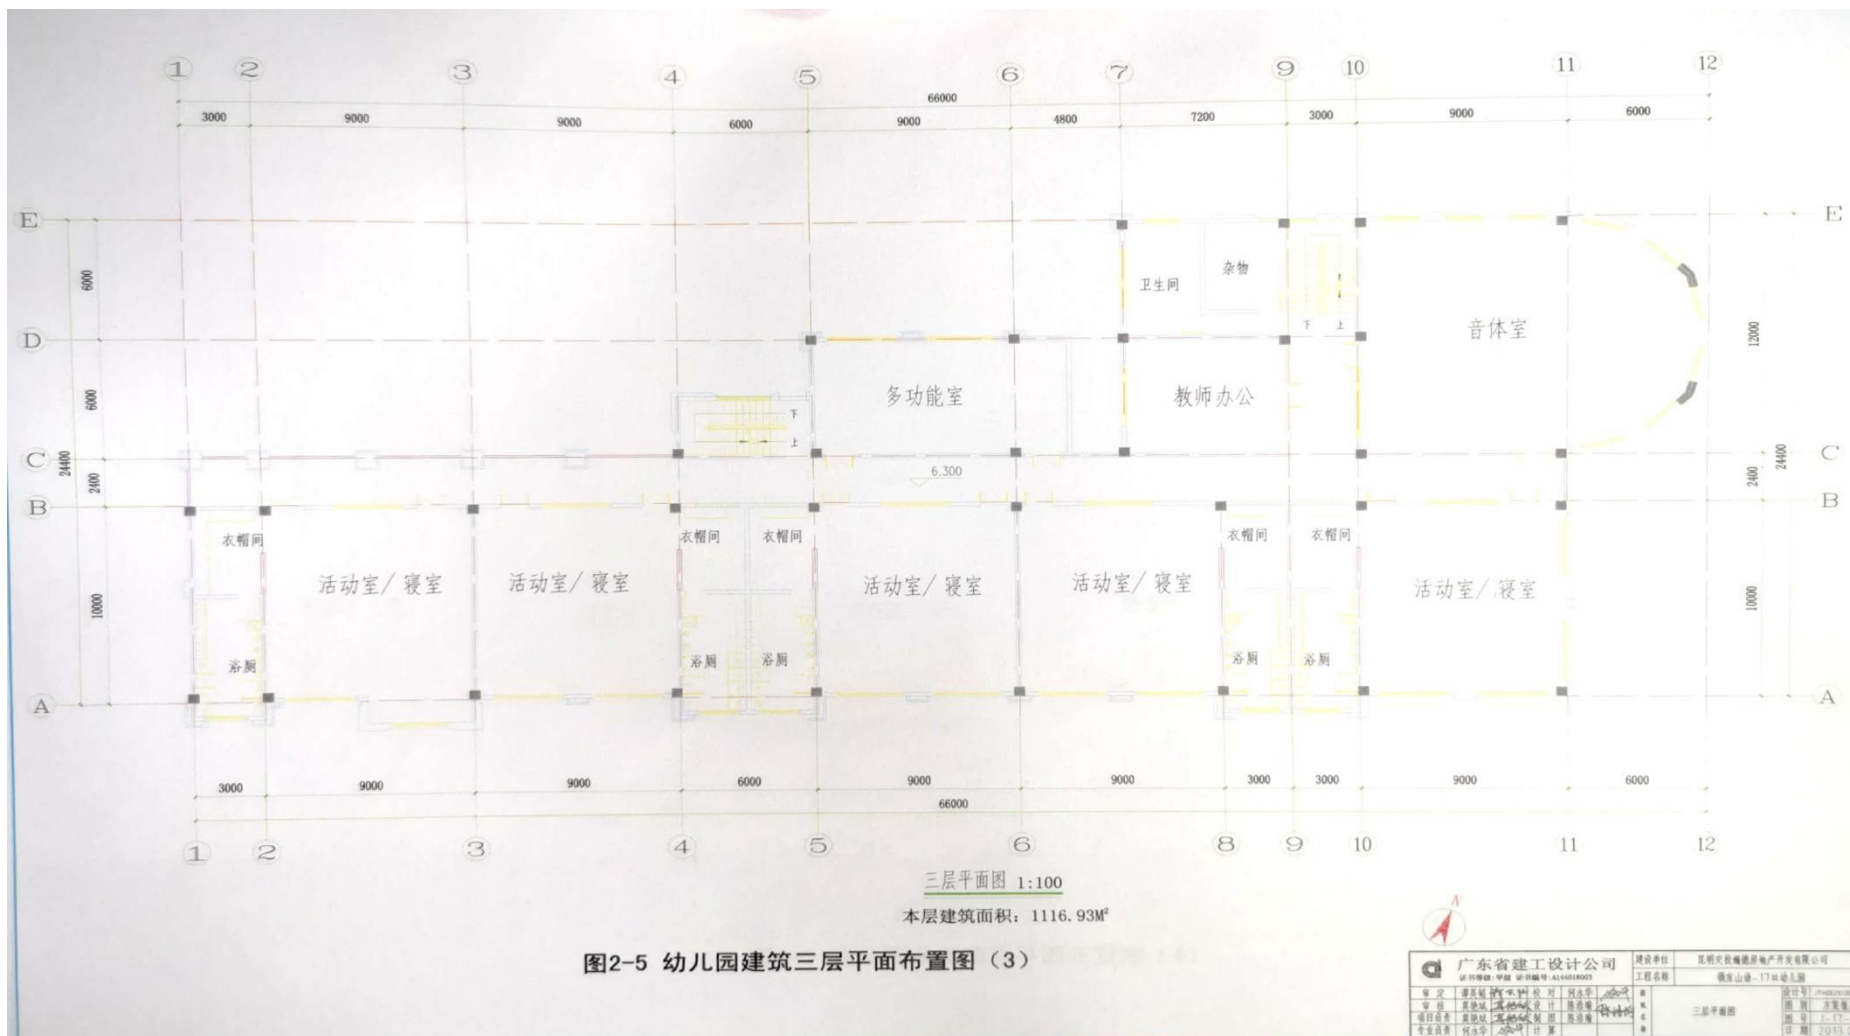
项目 A2 地块幼儿园地上三层平面布置图
